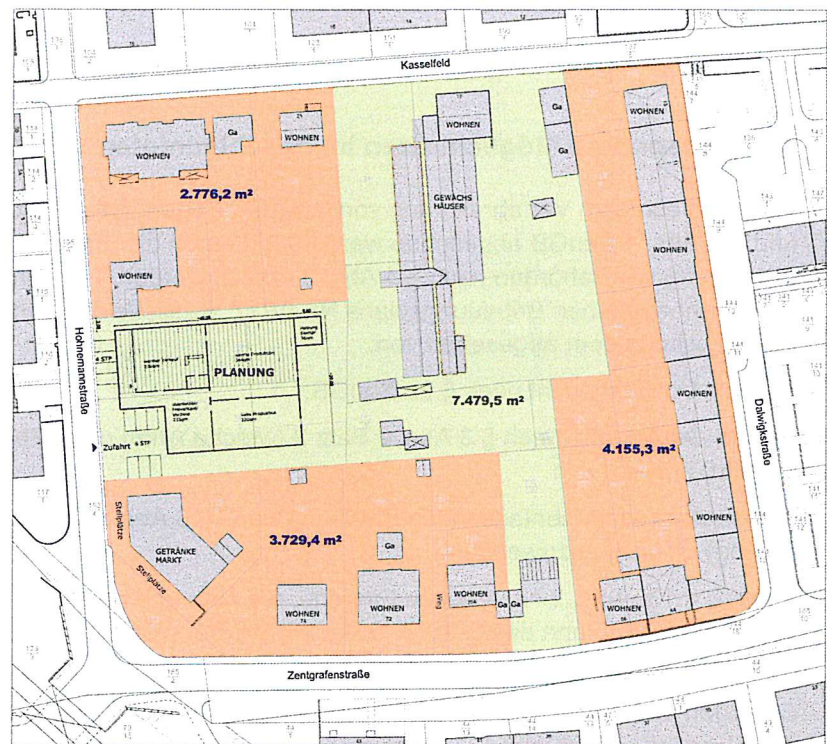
Flächenaufteilung des Plangebiets (ohne Maßstab)
